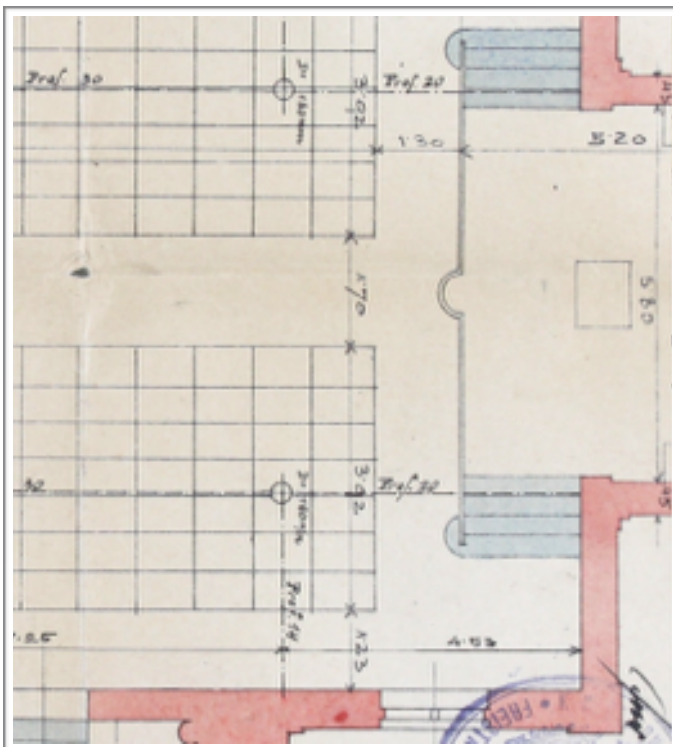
Ausschnitt Grundriß Erdgeschoß
